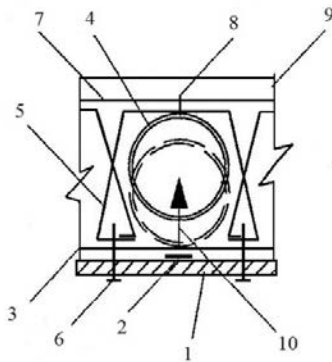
Схема фиксации вкладышей в облегченном перекрытии: 1 – опалубка; 2 – подкладки для фиксации защитного слоя; 3 – арматура нижней сетки; 4 – вкладыш; 5 – фиксаторы вкладышей; 6 – металлическая скоба; 7 – арматура верхней сетки; 8 – мягкая проволока; 9 – бетонная смесь; 10 – выталкивающая сила
